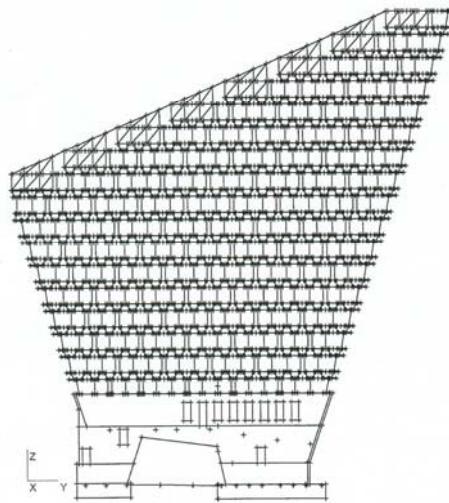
Stadhuis Leyweg Den Haag. Het betreft een gevelaanzicht voorzien van een elementindeling en een rekenschema van de gehele dragende gevel
